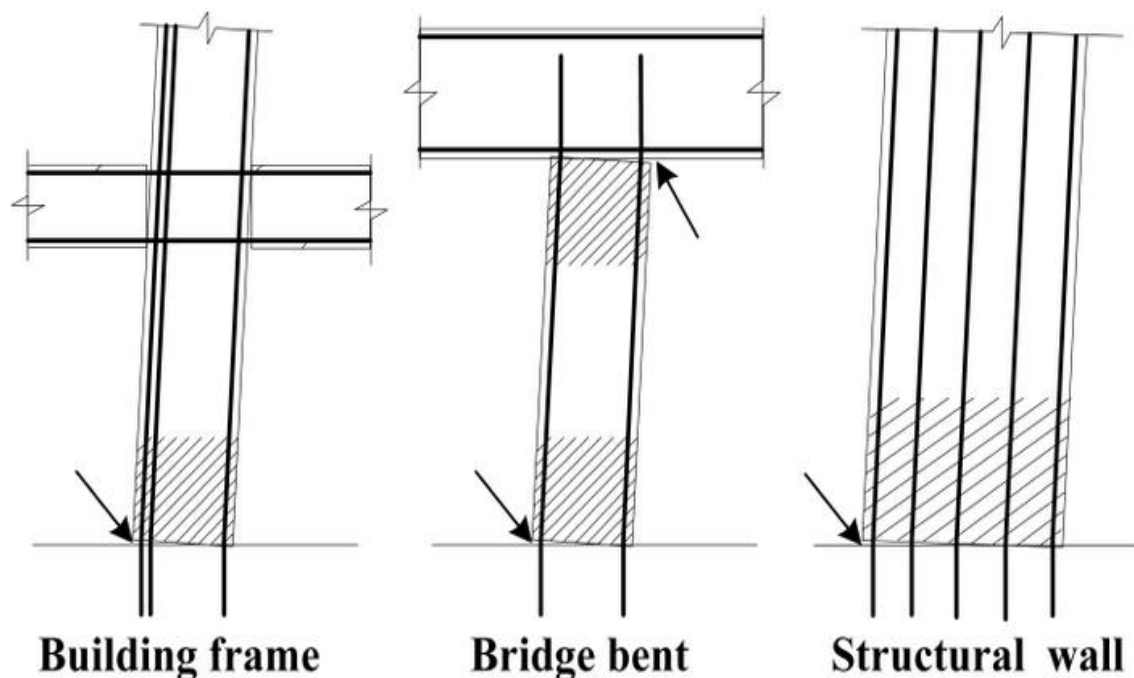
Elemento fibra más efectos de deformación por penetración.
